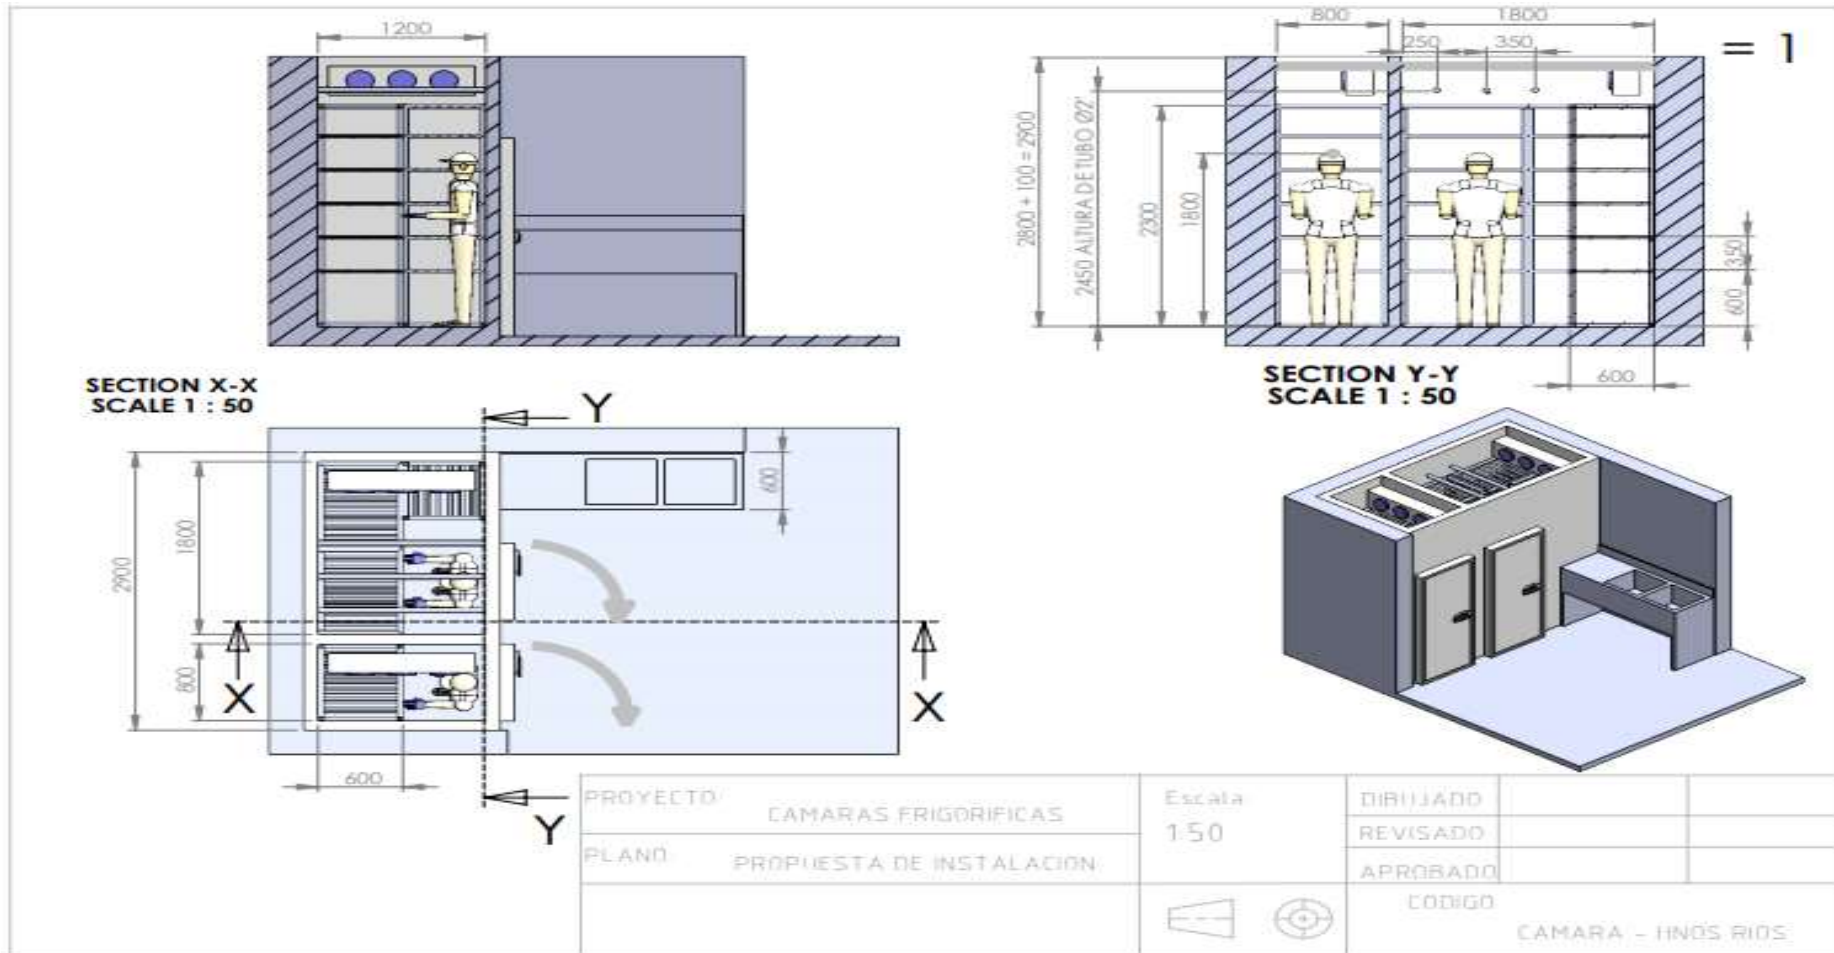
Plano mejorado de la máquina: Cámara Frigorífica – Vista de planta y frontal. Fuente: Codem Tech Perú SAC.
